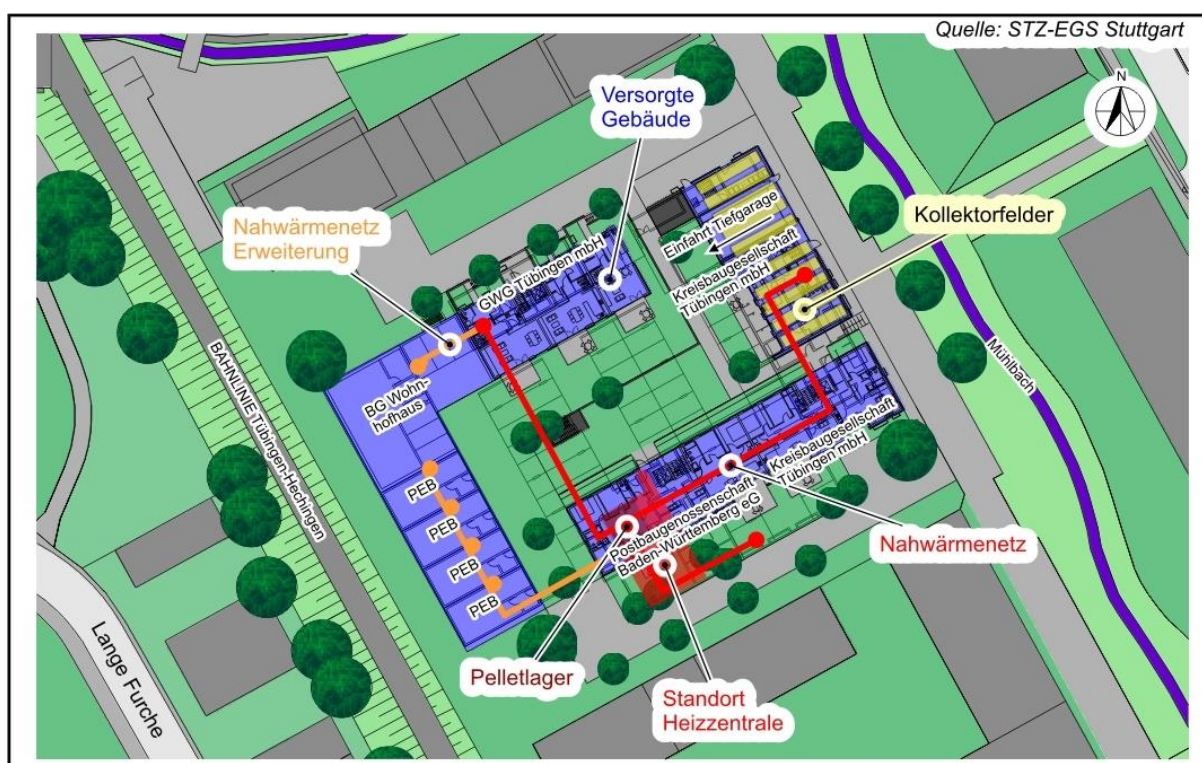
Lageplan Tübingen, Mühlenviertel – Quartier Sonnenmühle
